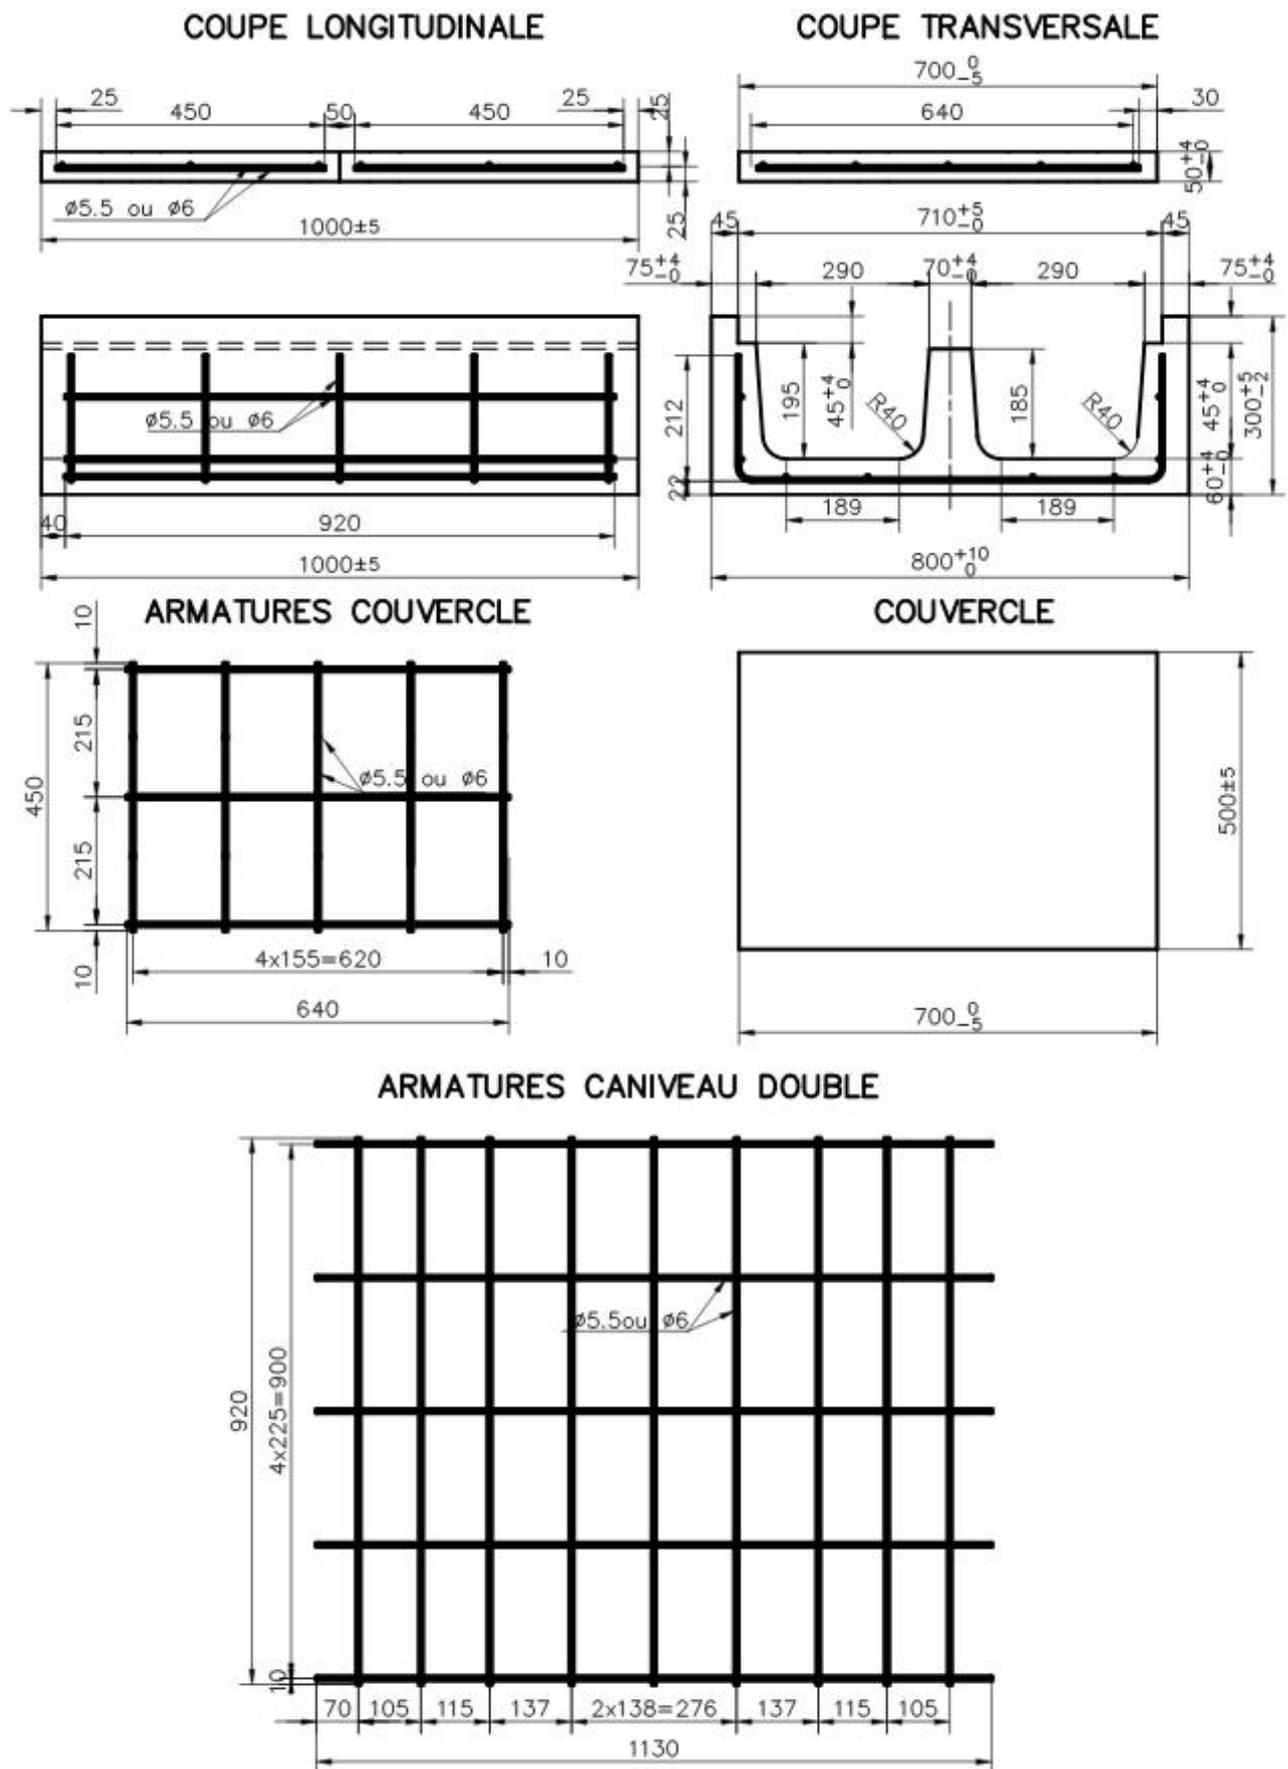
double caniveau à câbles avec 2 couvercles encastrés (dimensions en mm)
